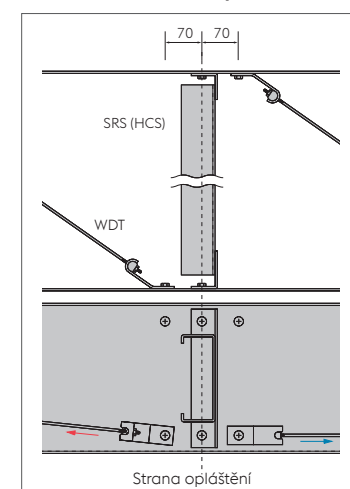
Detail konstrukčního uspořádání vyvěšení paždíkы pro rozpětí 10.6 – 13.00 metrů
